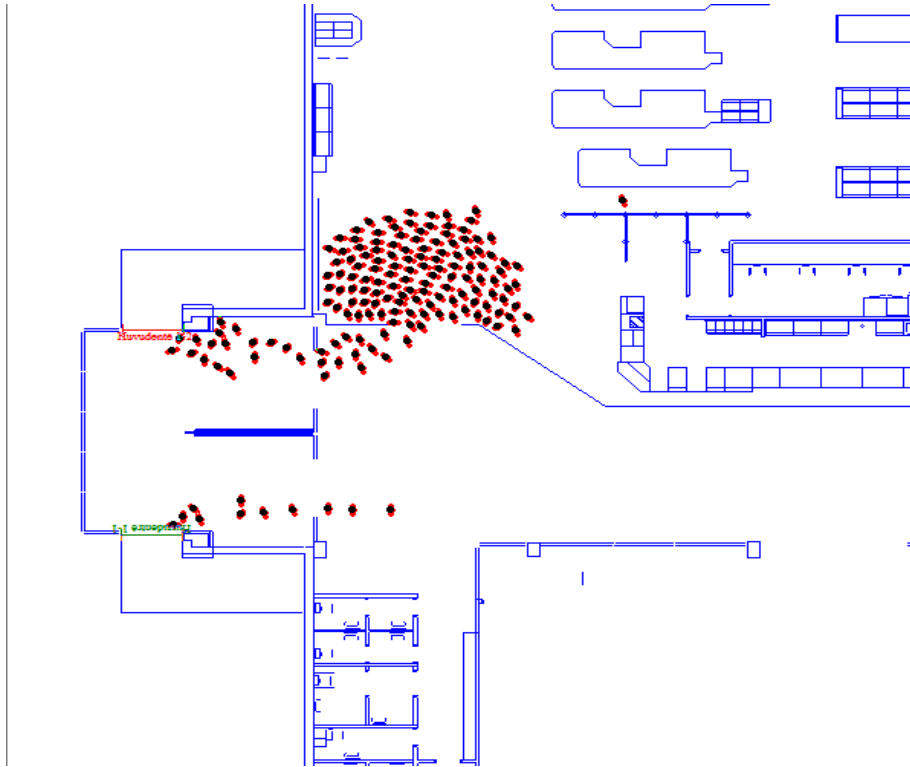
Samtliga utrymningsdörrar på Sveaplan köpcentrums nedre plan.
